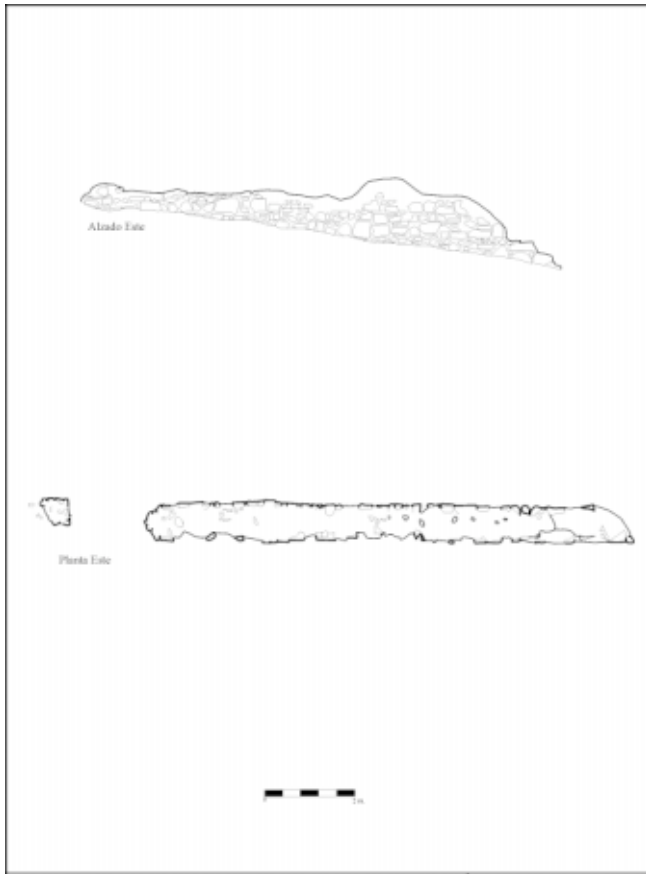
Castellum Aquae. Planta y Alzado. Muro Este.
